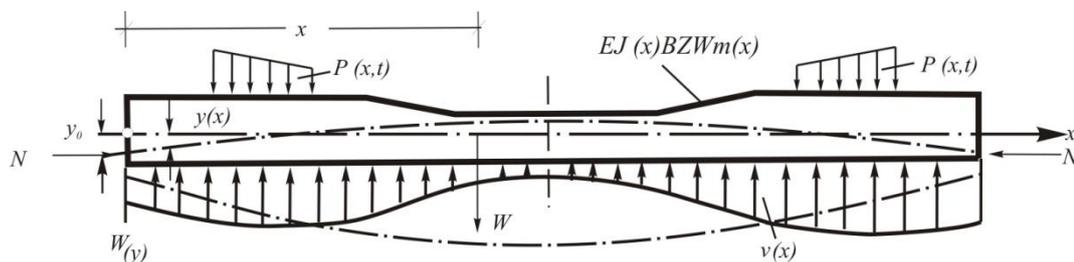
Расчетная схема железобетонной шпалы, принятая Комитетом ОСЖД
